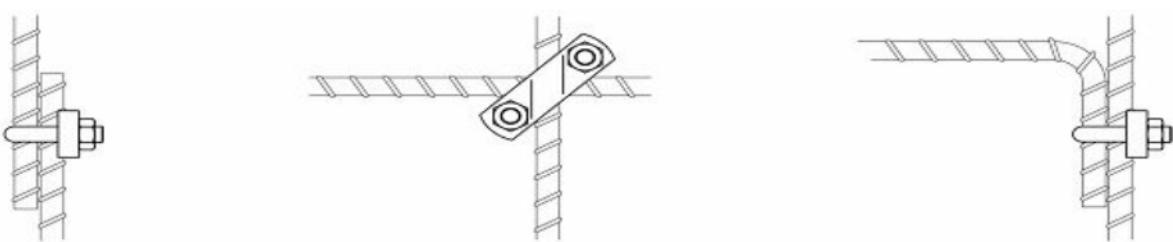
Затискні з'єднання за майбутніми стандартами серії 62561
